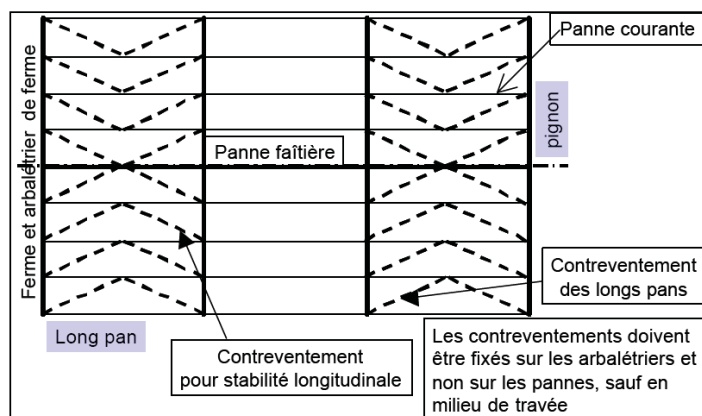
Exemple d'un plan de contreventement en V d'une charpente traditionnelle de grande dimension [AFP 05]
